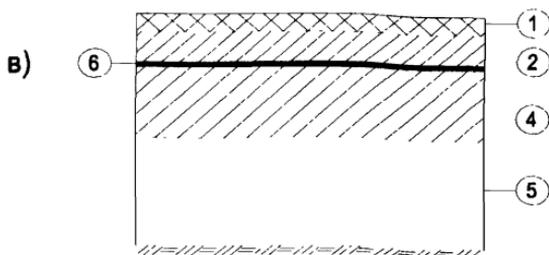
в - Геосетка уложена на бетонное основание под двух-
